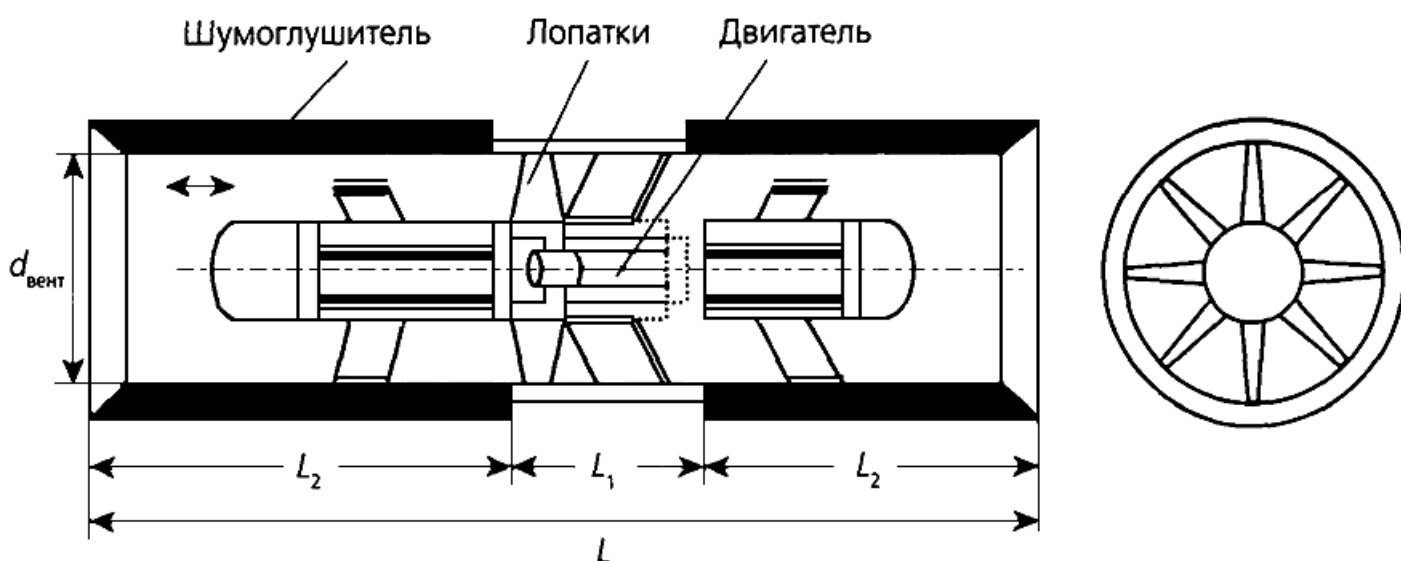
Конструктивная схема реверсивного струйного вентилятора: L - общая длина струйного вентилятора; L_1 - длина вентилятора с двигателем и крыльчаткой; L_2 - длина шумоглушителя
